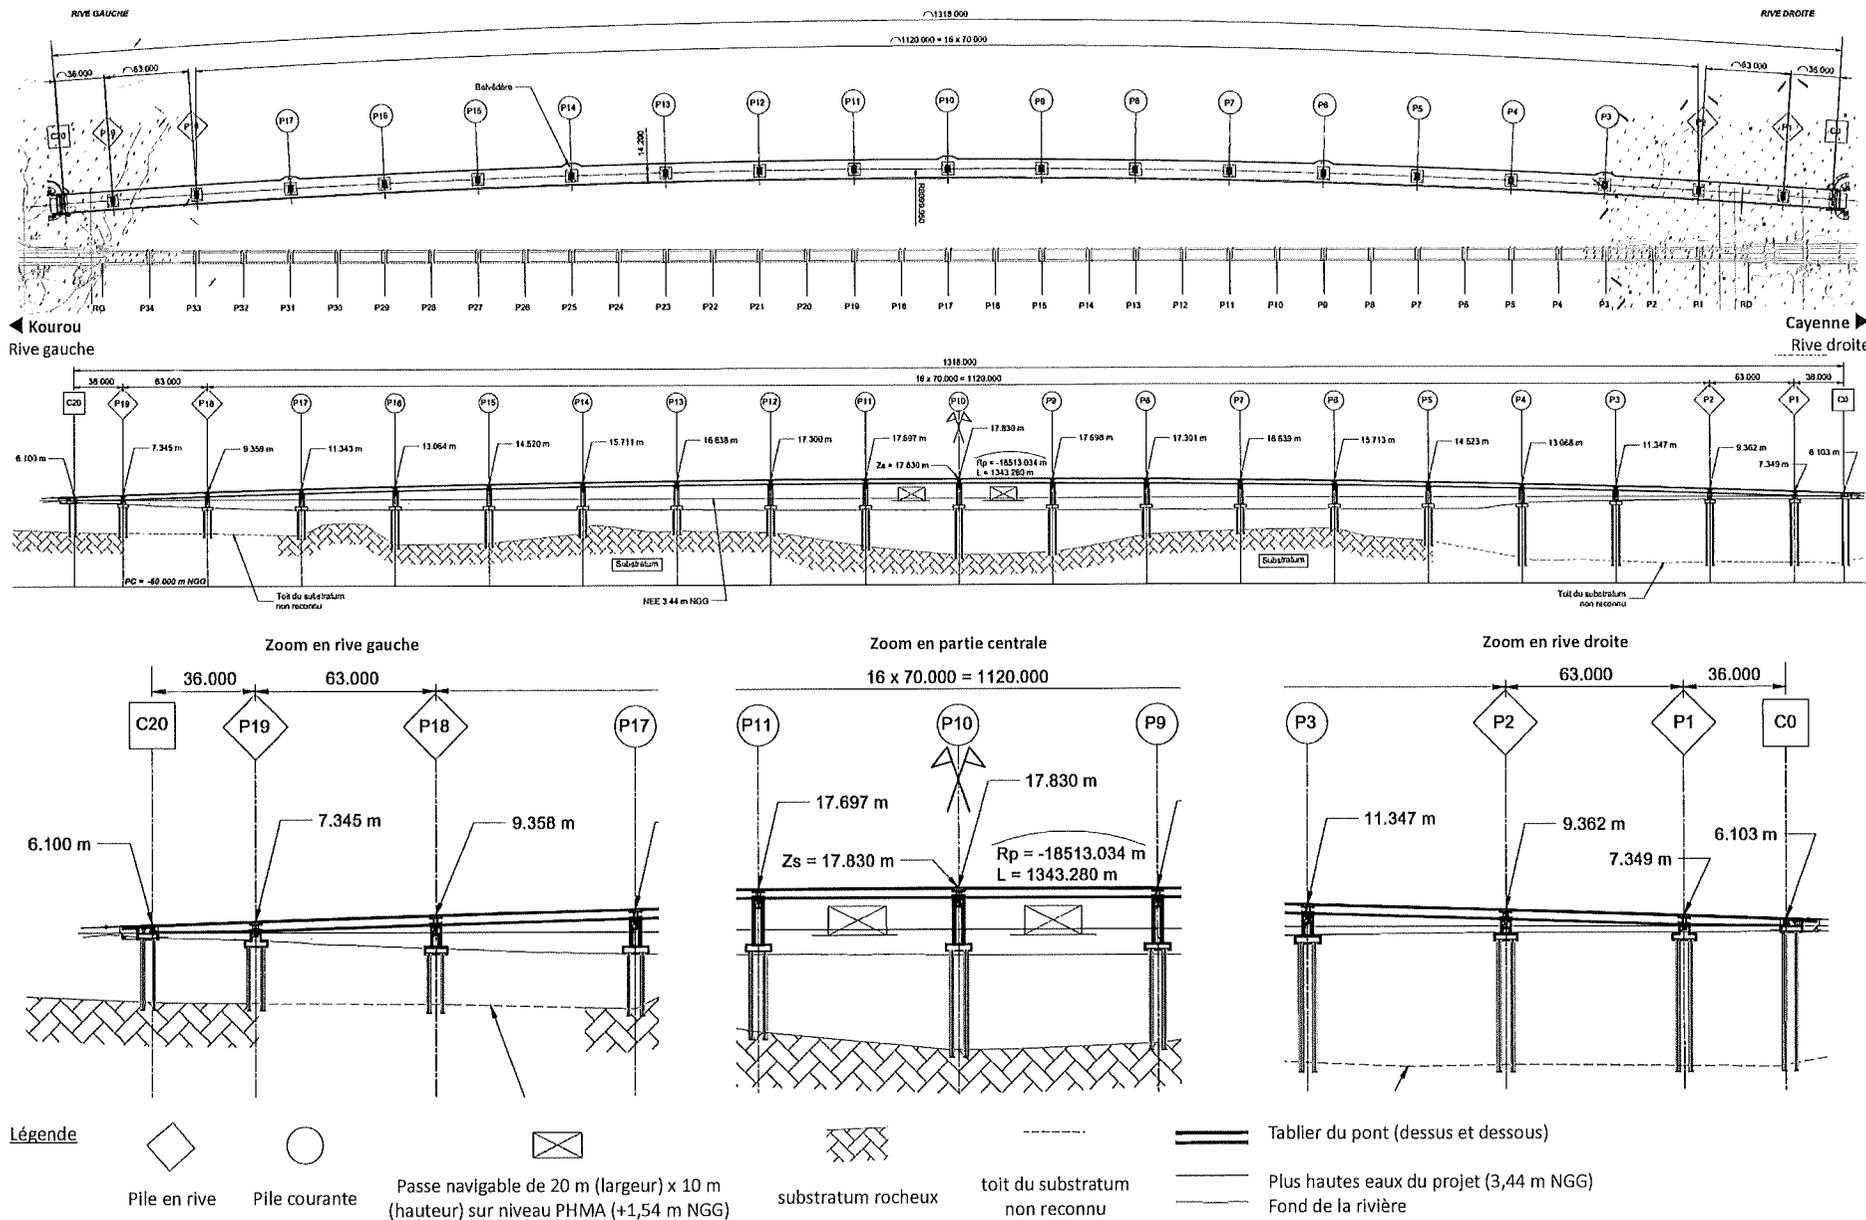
vue en plan et coupe longitudinale – solution avec tablier en béton de hauteur constante (source : Egis)
